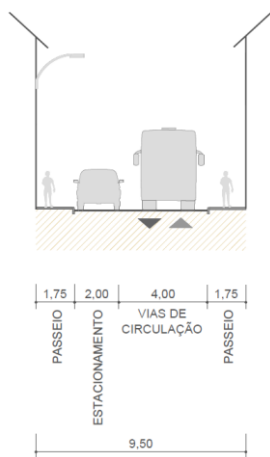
Secção tipo existente J - Rua Dom Pedro V
